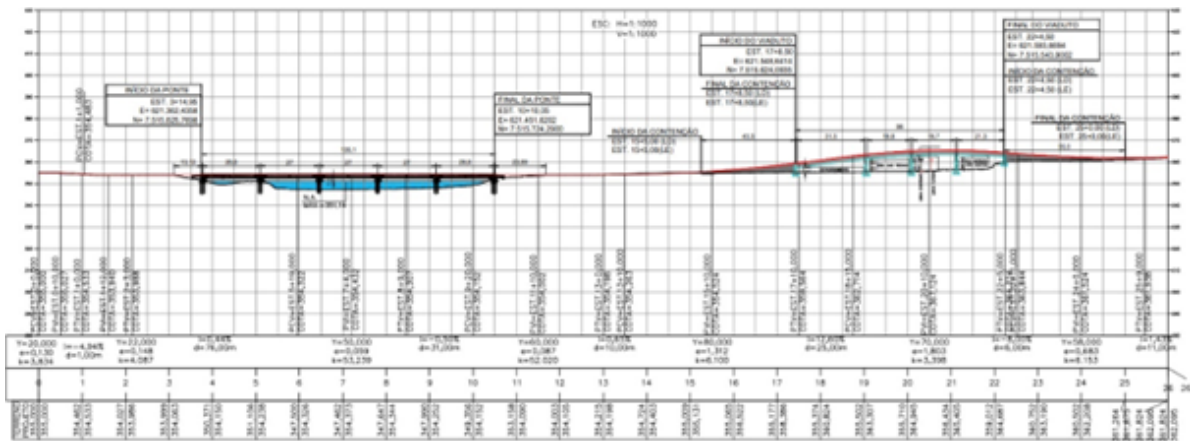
Seção longitudinal da Ponte e Viaduto do Complexo Viário.
